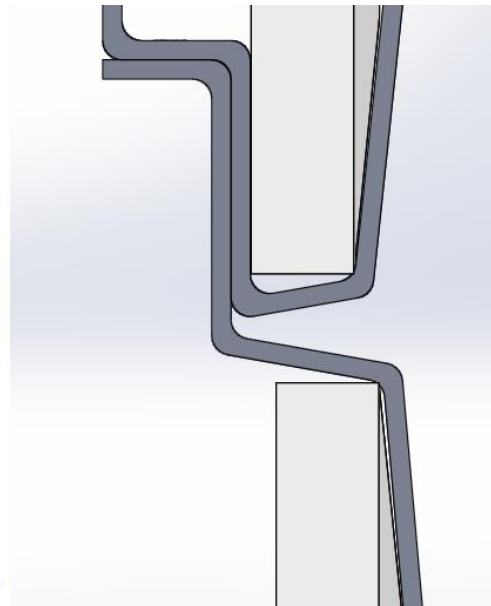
Soporte alternativo para paneles con apoyo con paneles integrados
